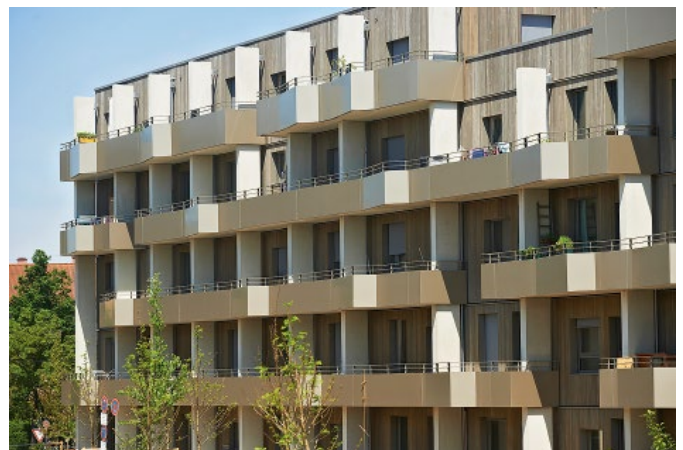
Wohnanlage der WOGENO München eG in der Limmatstraße in München, Architekten: agmm Architekten & Stadtplaner GmbH, Holzbau: Anton Ambros GmbH
